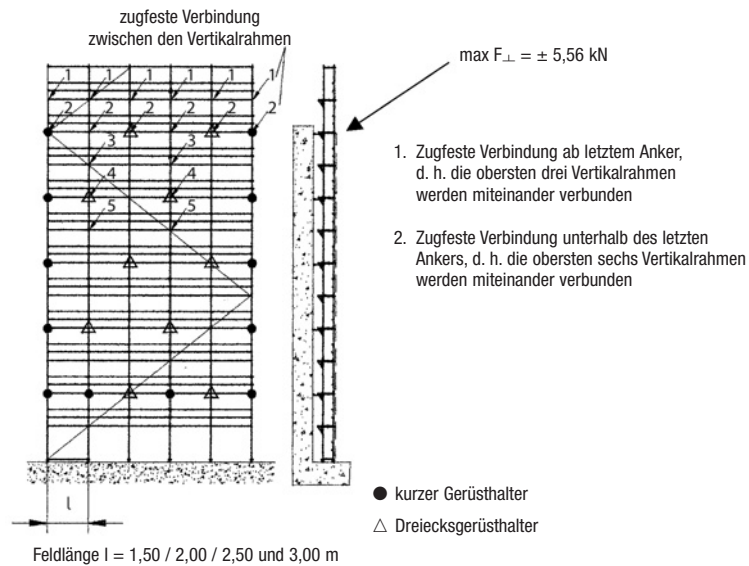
Über der letzten Verankerung freistehende Gerüstlagen; unbedecktes Gerüst mit Innenkonsolen vor offener Fassade
